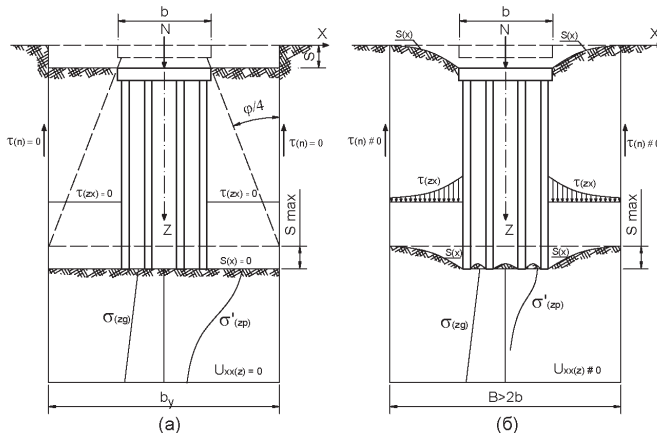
Геомеханические расчетные модели грунтового массива по [3] (а) и по предложению [5] (б) для определения осадки свайного фундамента
